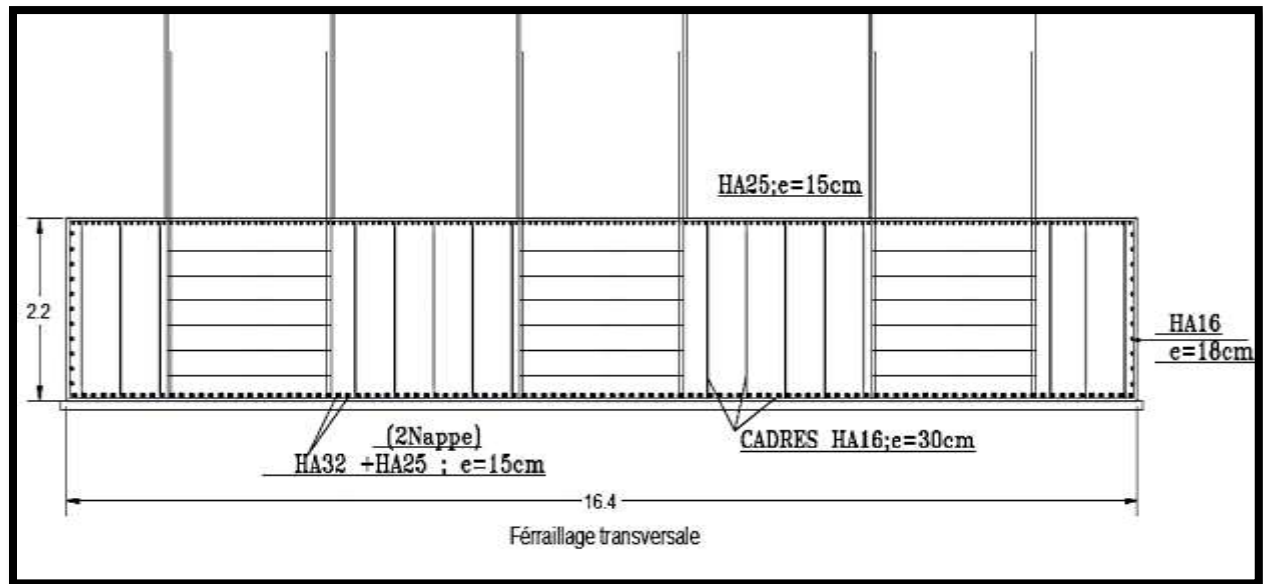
Schéma de ferrailage transversale de la semelle
